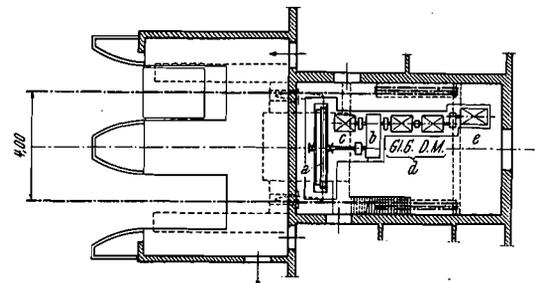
Bergstation einer Personenseil-schwebbahn mit Pendelbetrieb
